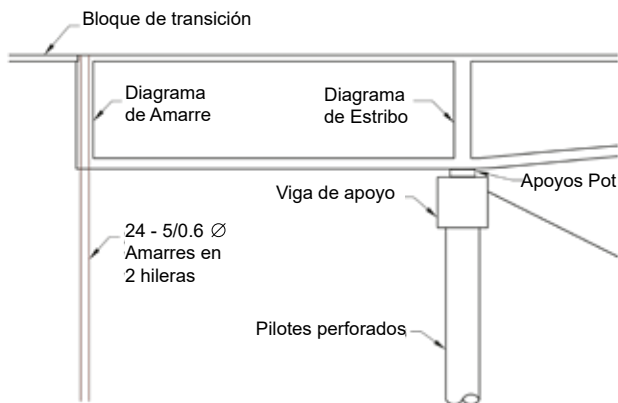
Detalles en la ubicación de los estribos y los amarres
